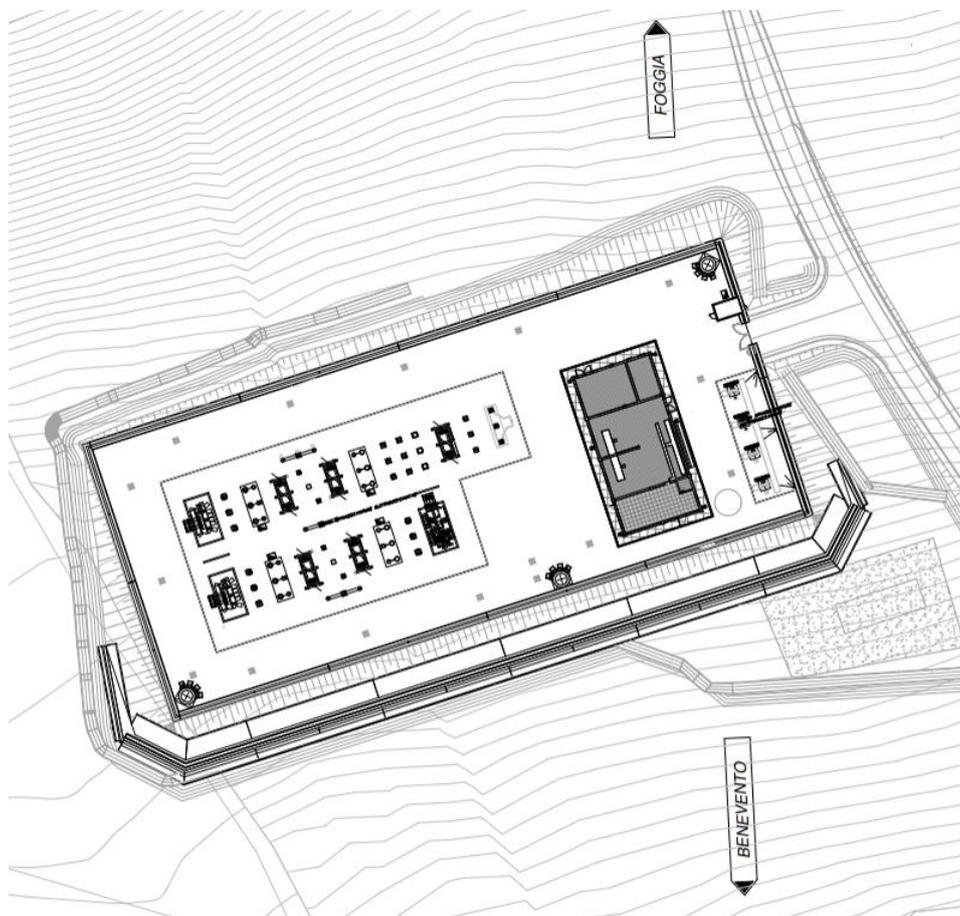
Stralcio della planimetria di inquadramento dell'area della sottostazione del Progetto Esecutivo
